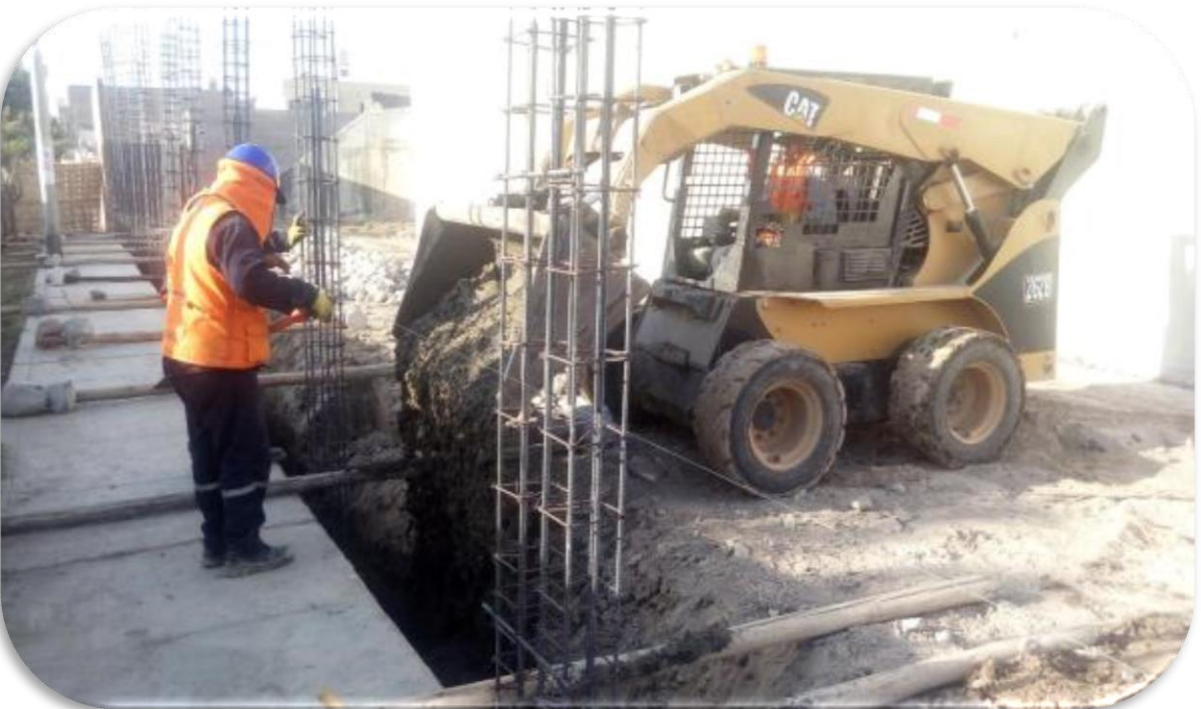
PODEMOS OBSERVAR EL VACIADO DE CONCRETO PARA CIMENTO CORRIDO CON DOSIFICACION 1:10 MÁS 30% DE PIEDRA GRANDE.
